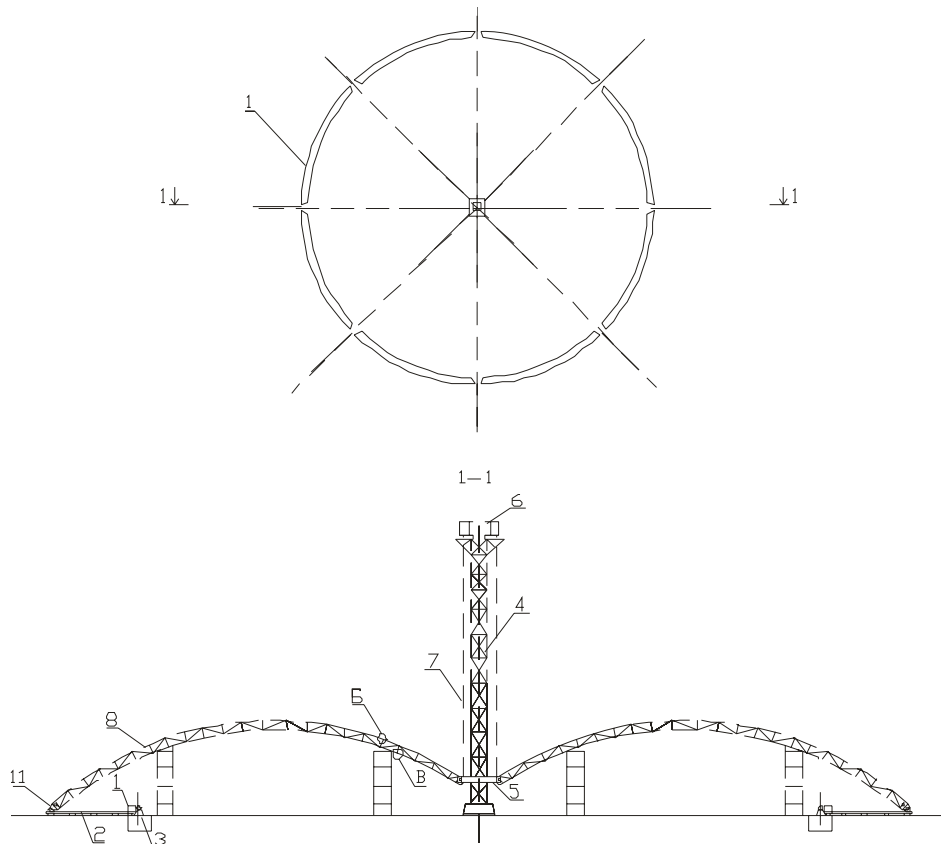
Монтаж кружал и временной опоры купола. 1 – сегменты опорного кольца; 2 – роликовые пути; 3 – опорный шарнир; 4 – временная опора; 5 – подъемное кольцо; 6 – лебедка; 7 – тросы; 8 – кружала.
